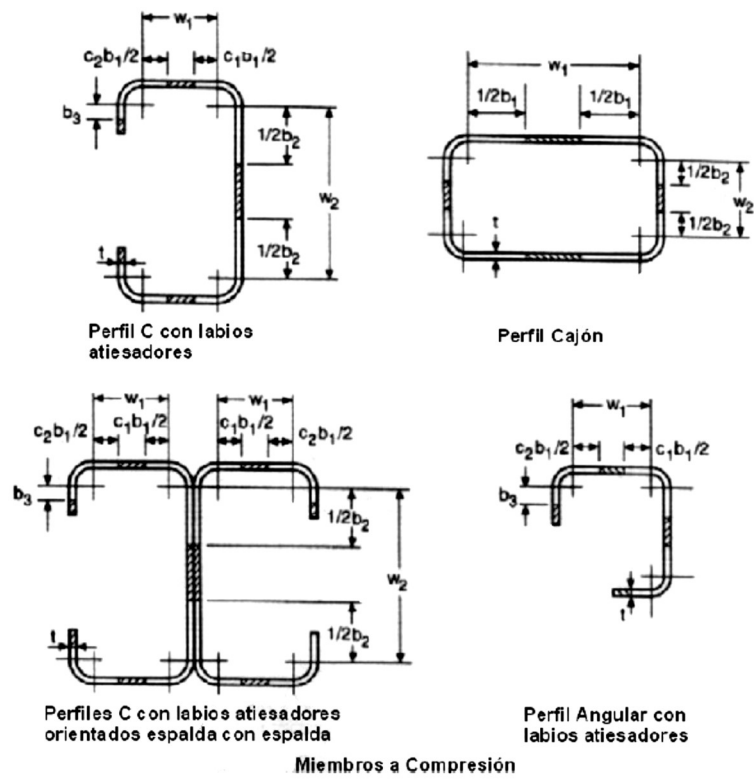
Ancho efectivo de elementos atiesados sometidos a compresión.
